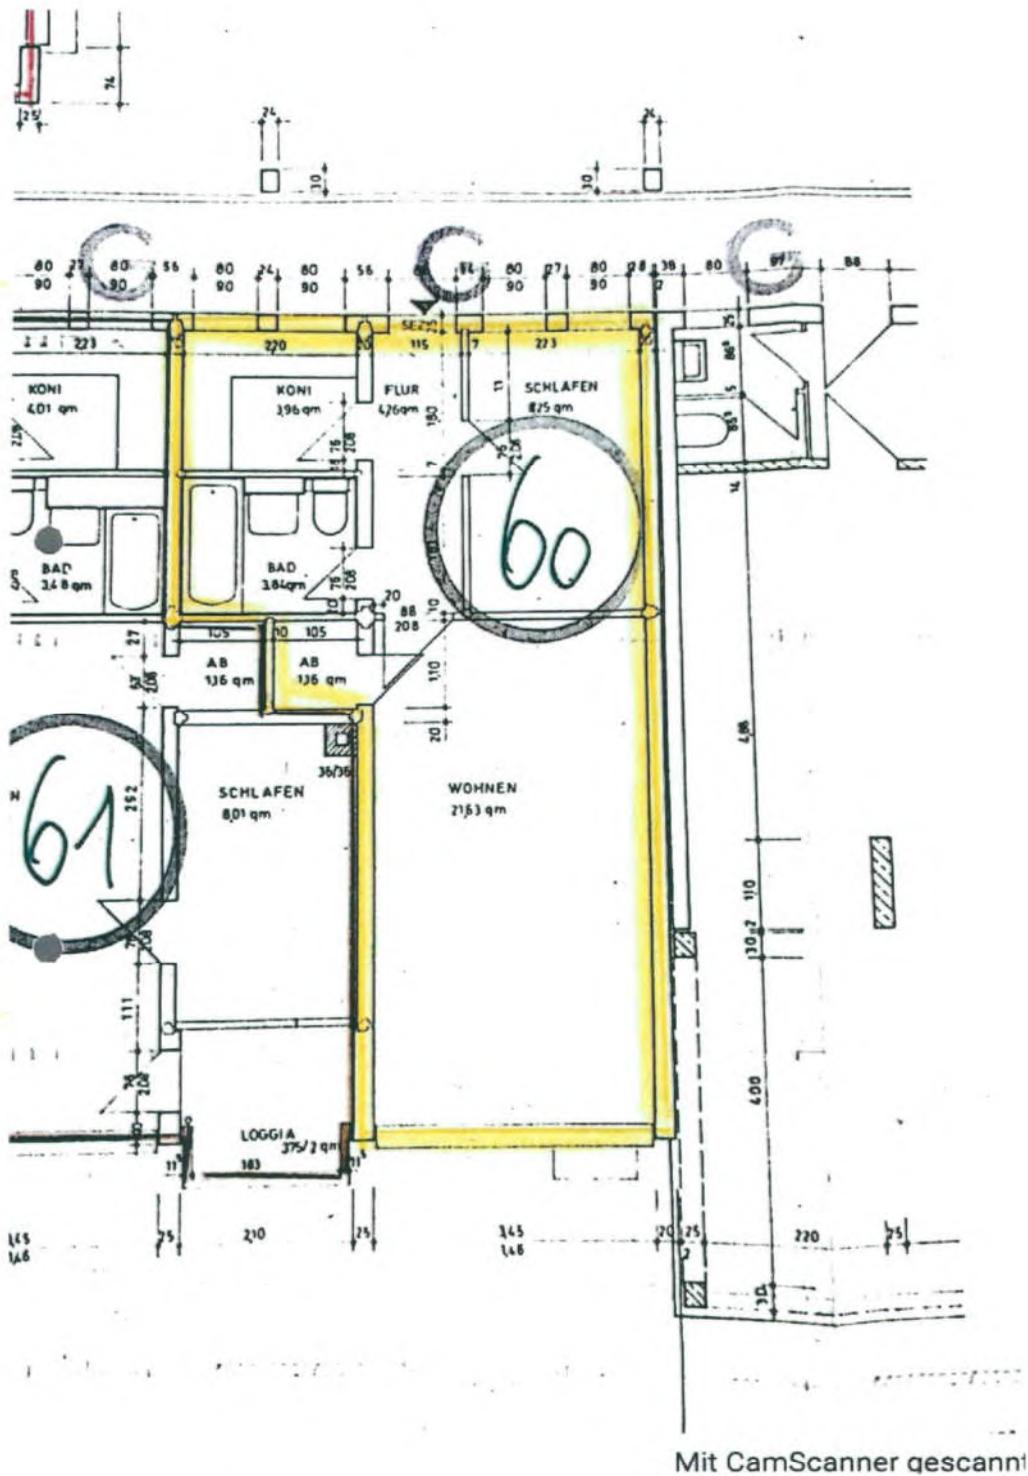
Grundriss mit Kennzeichnung Wohnung Nr. 60
